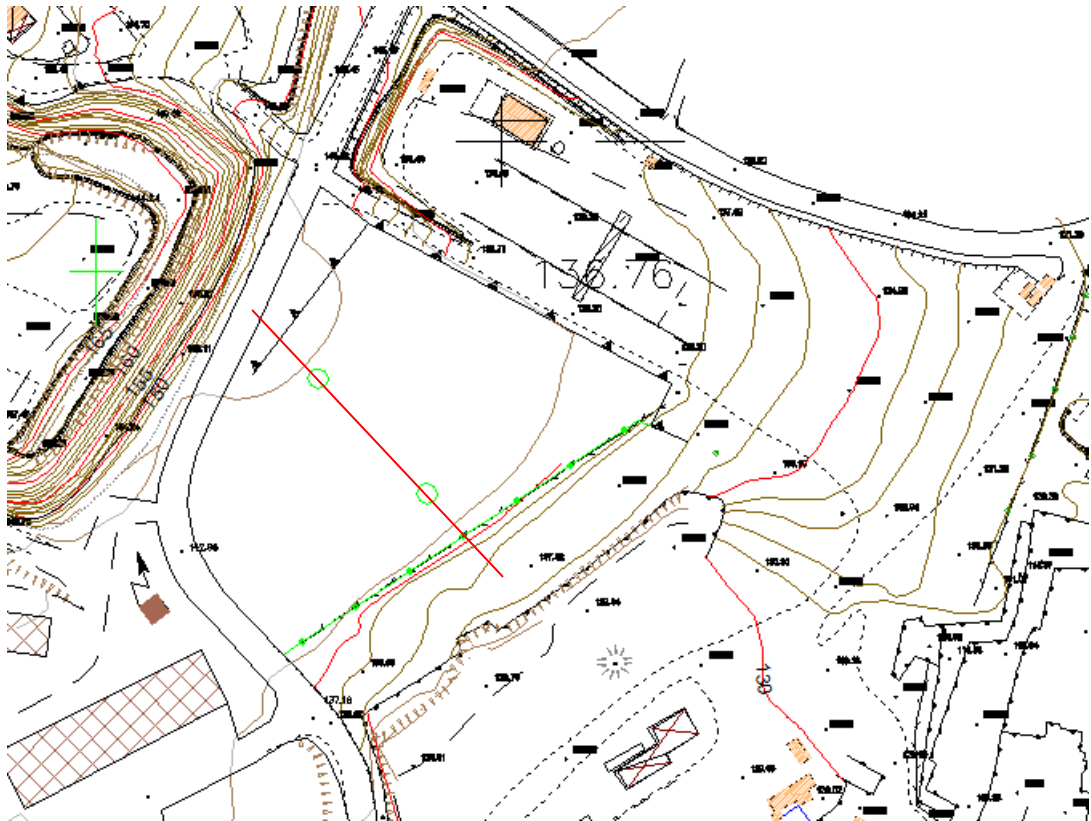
planimetria stato attuale con traccia della sezione utilizzata per le analisi di stabilità di pendio
